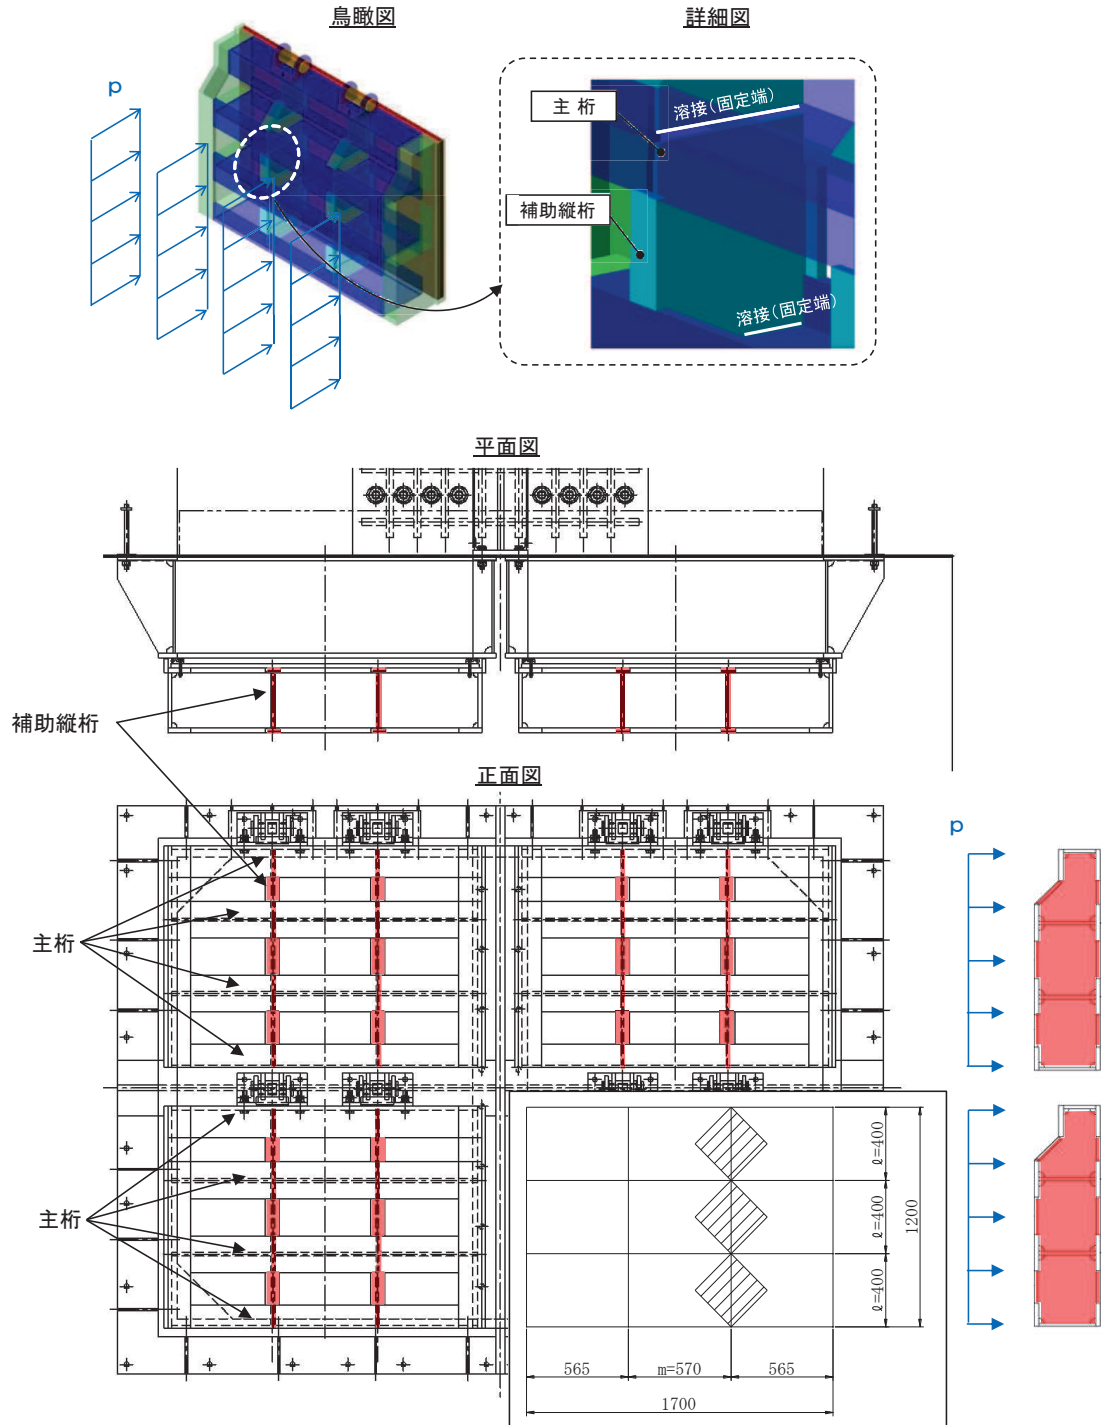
補助縦桁の構造図及びモデル図 (単位: mm)
